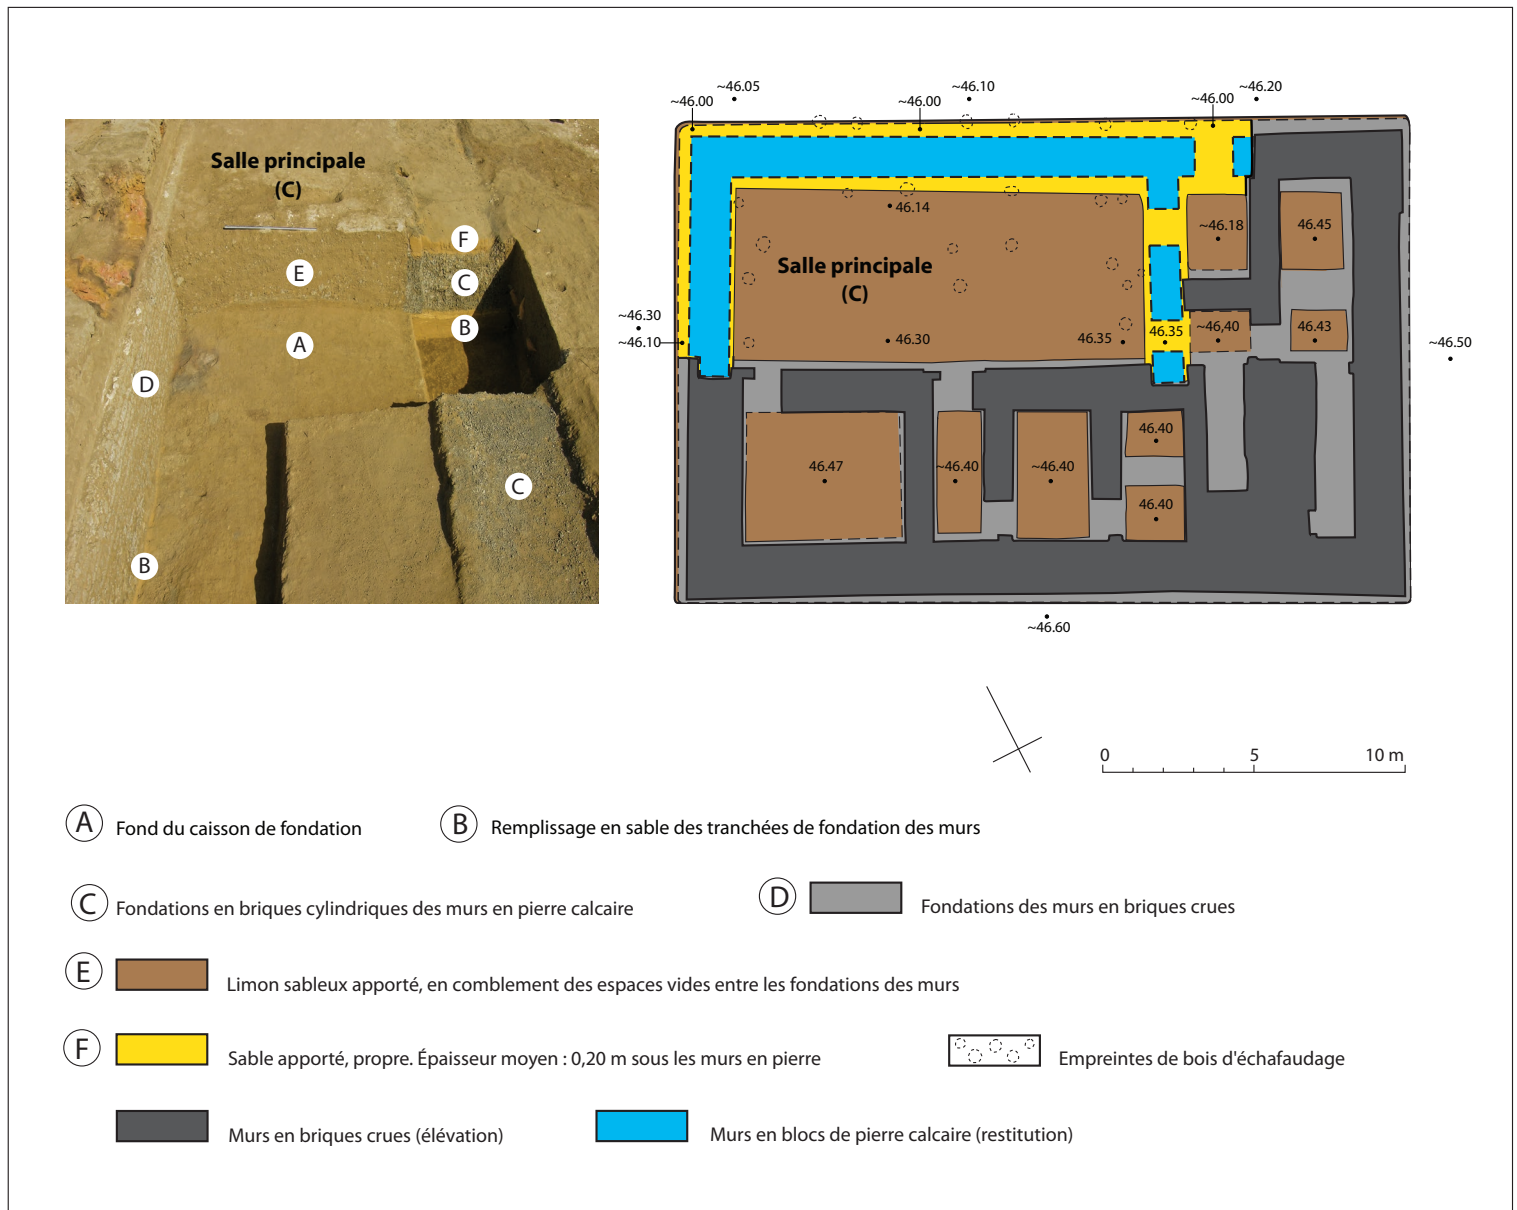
Fondations du palais : dernier lit de sable sous les murs en pierre calcaire et première assise des élévations
